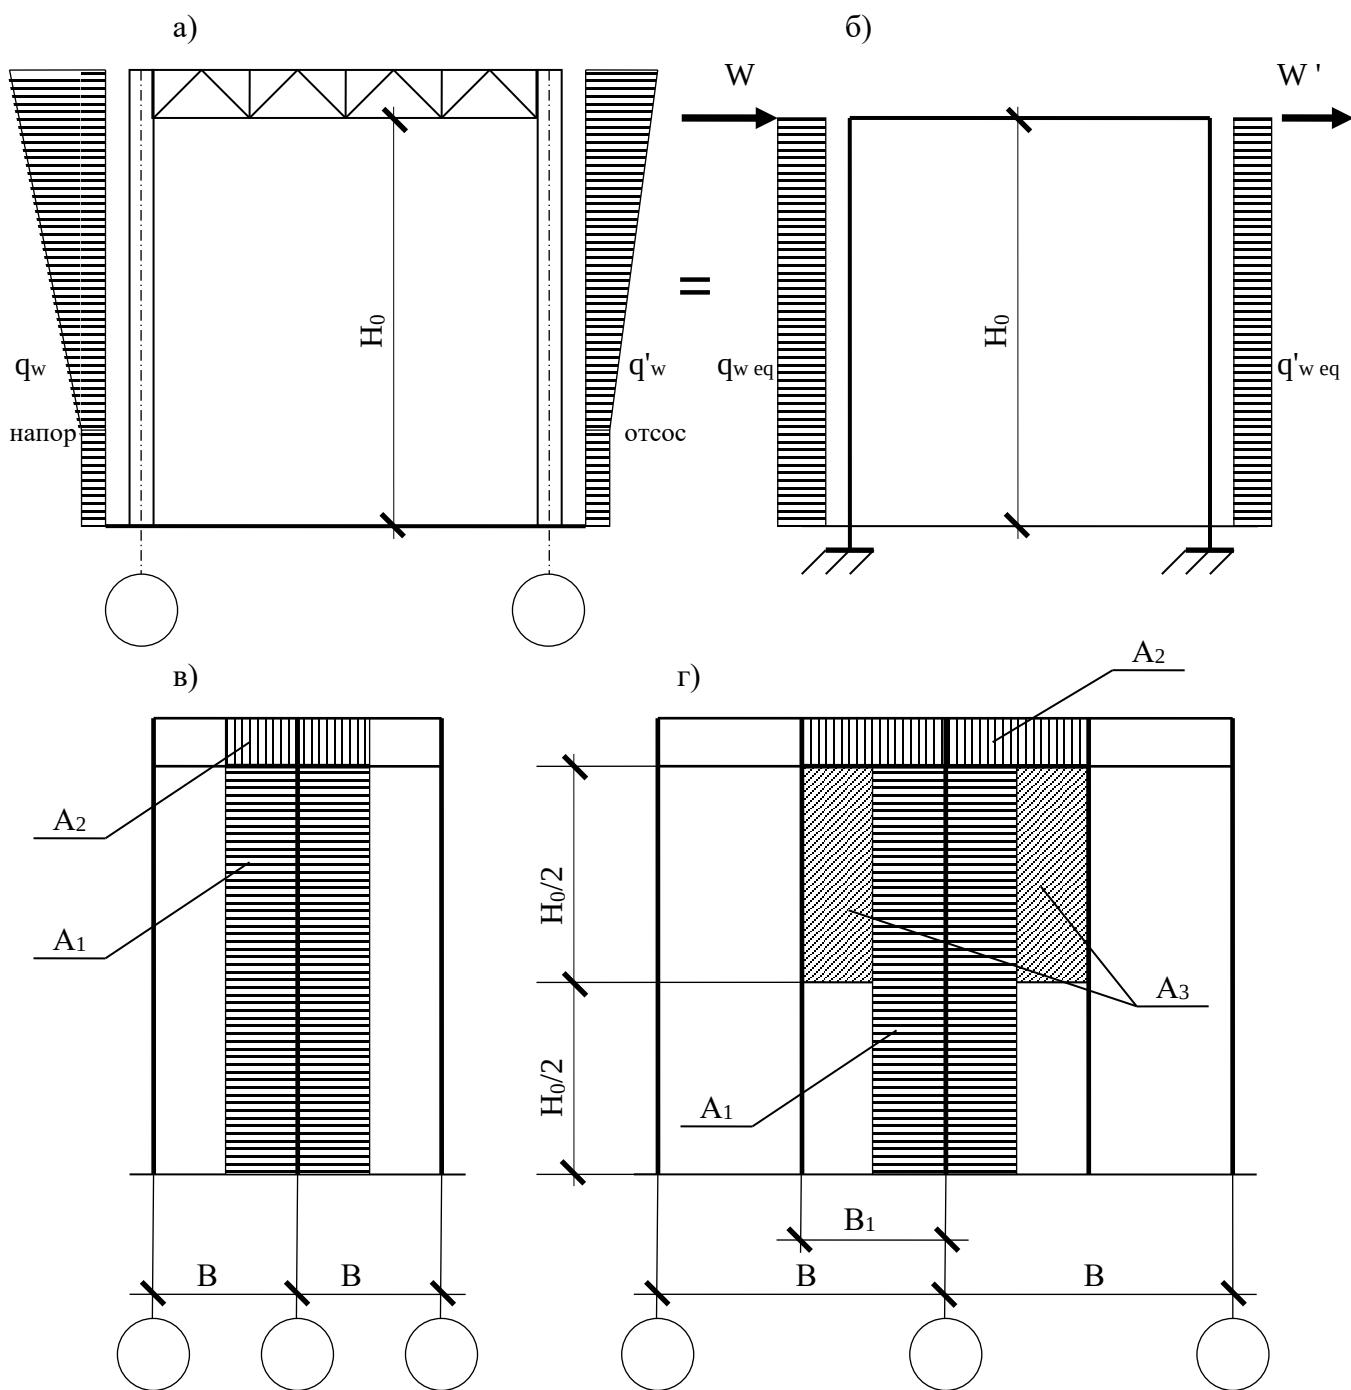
Схема загрузки рамы ветровой нагрузкой:
